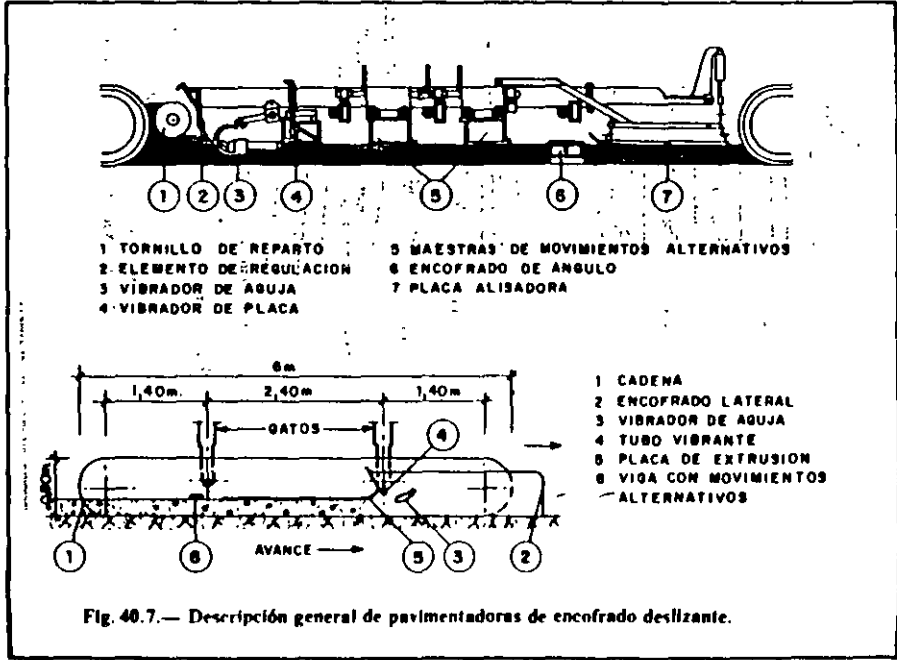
Descripción general de pavimentadoras de encofrado deslizante.
